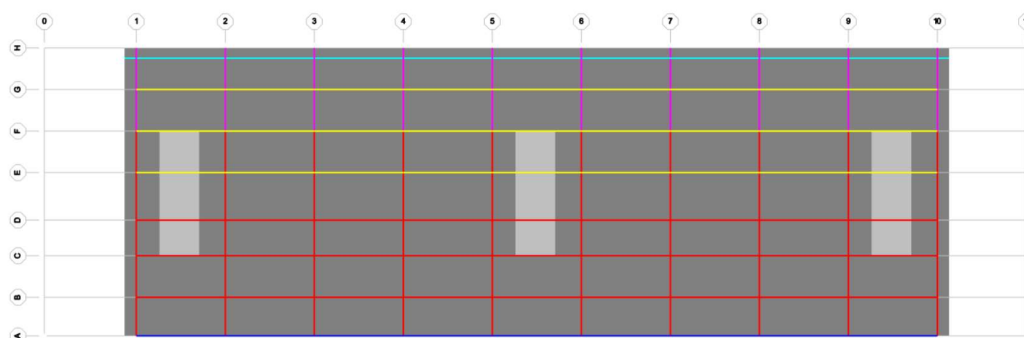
Modelamiento de la cubierta o tablero del muelle
